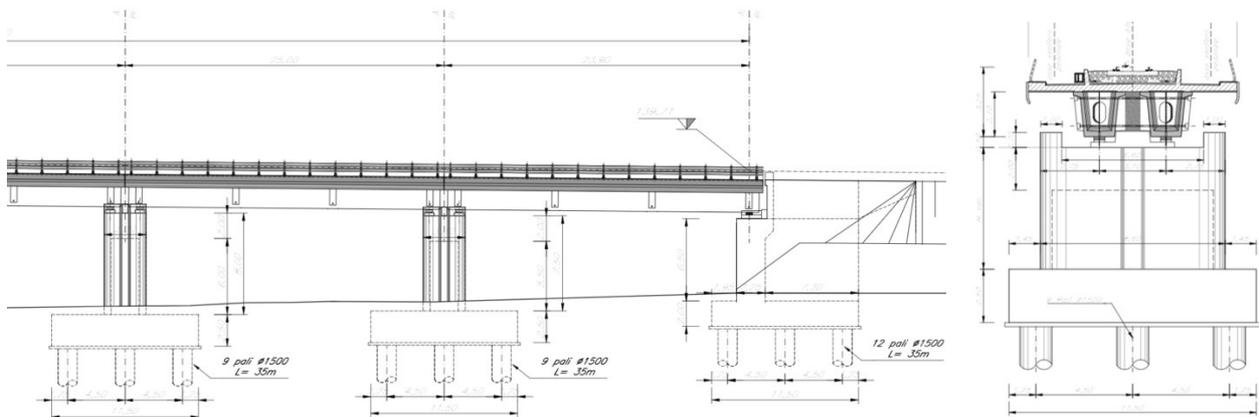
Viadotto VI09 – Profilo longitudinale - Sezione trasversale
